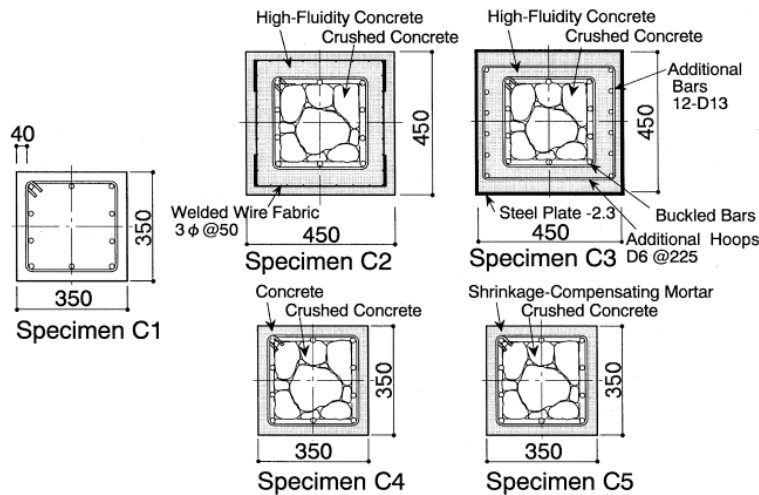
Secciones transversales de los columnas ensayadas de Fukuyama et al. (2000)
